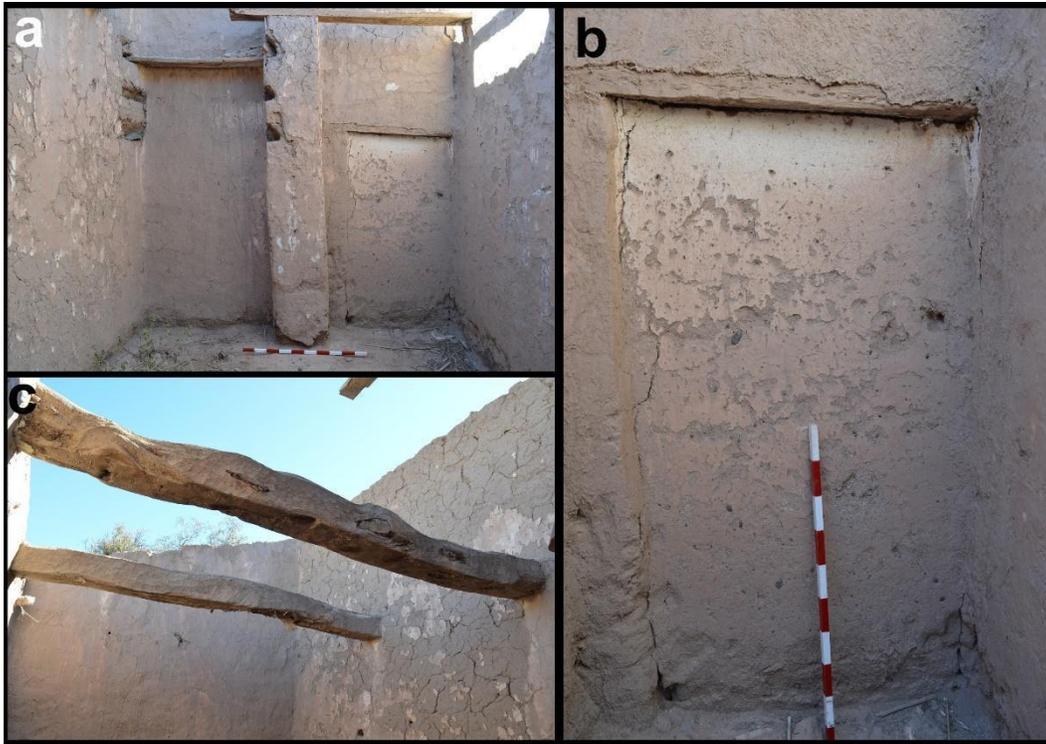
interior del R2. Referencias: (a) muro SE con las estanterías, la posible puerta cegada y la columna empotrada; (b) detalle de la abertura cegada; (c) vigas al interior del R2.
